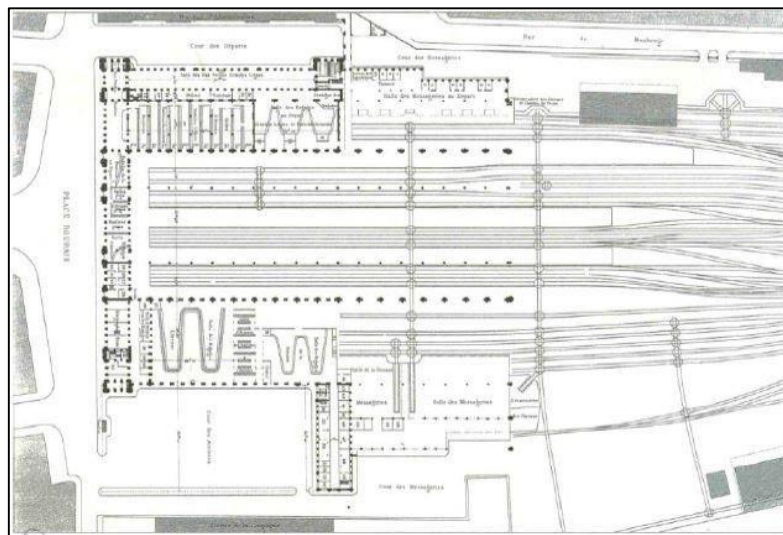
Plan de la gare ferroviaire de Lille II en 1892
